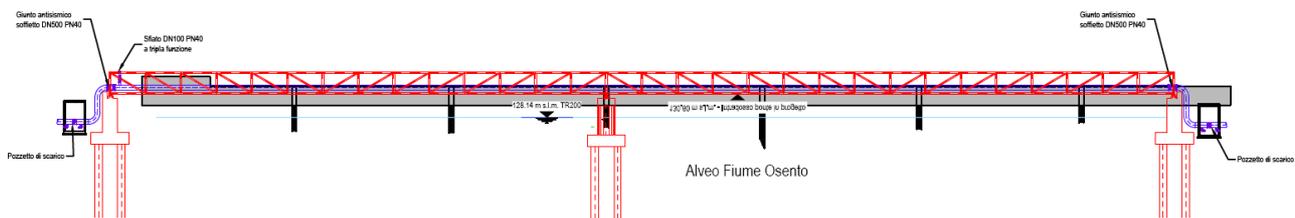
Sezione longitudinale attraversamento aereo di progetto sul Fiume Oseno.
